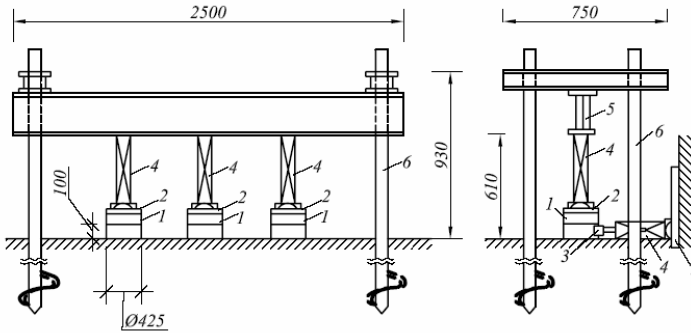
Схема установки для сдвига целиков грунта конструкции Фундаментпроекта:
